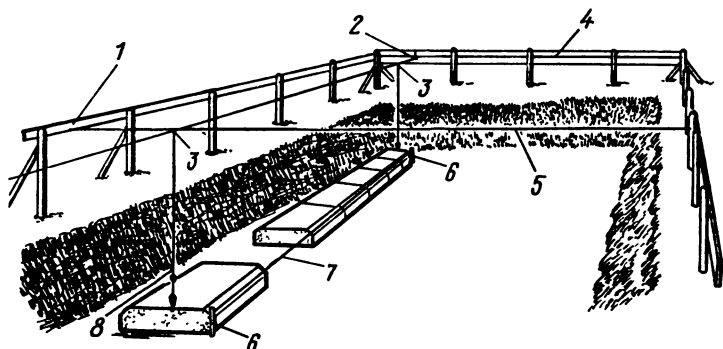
Перенесение осей фундаментов на дно котлована:
